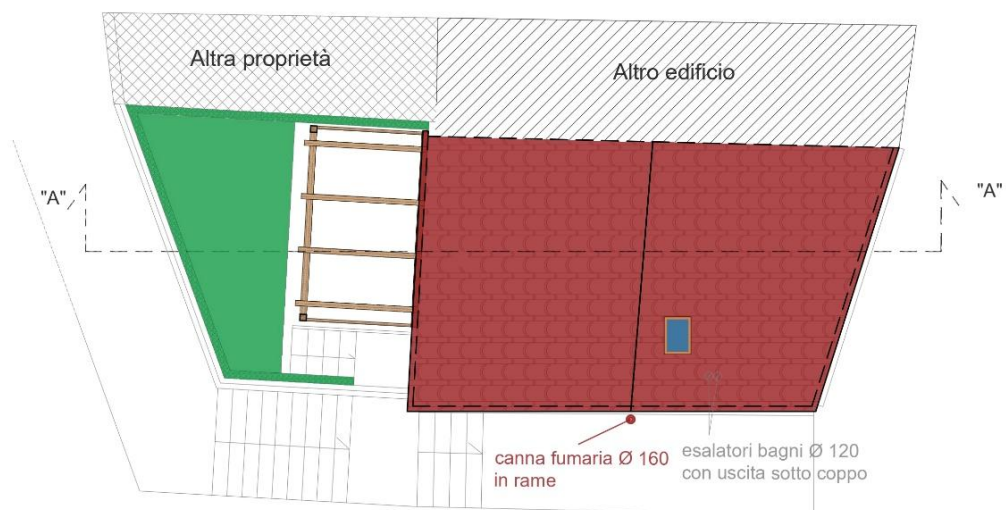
Stato futuro – Pianta piano Sottotetto e Copertura
